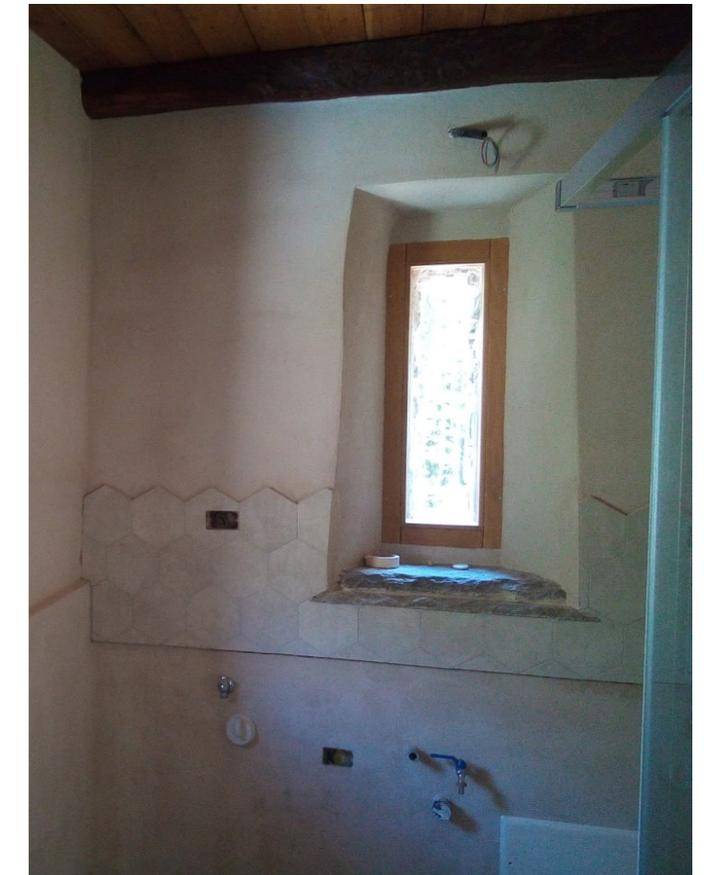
Vista interna con intonacatura in calce. Si notano anche la posa delle piastrelle. (Foto di Yann Crivelli)
